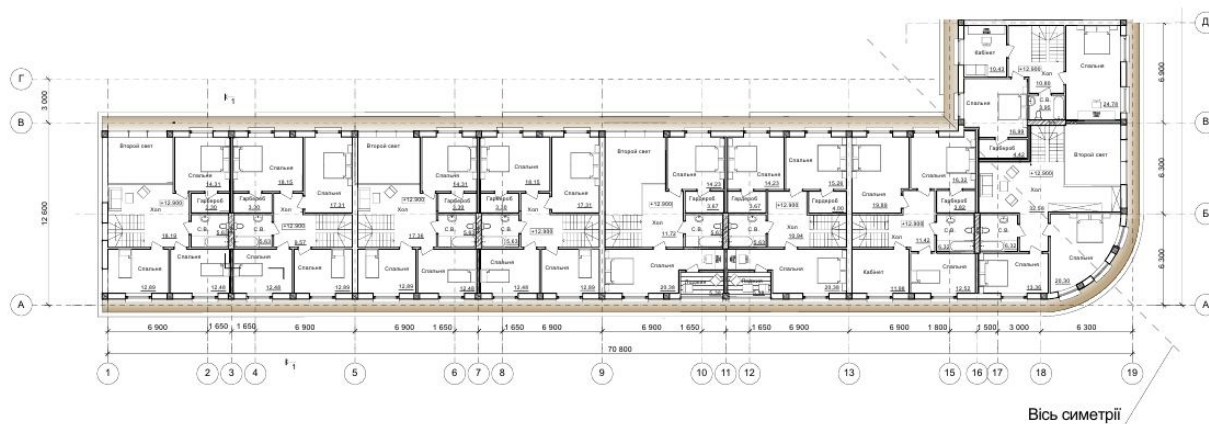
Приклади оформлення планів поверху житлового будинку
